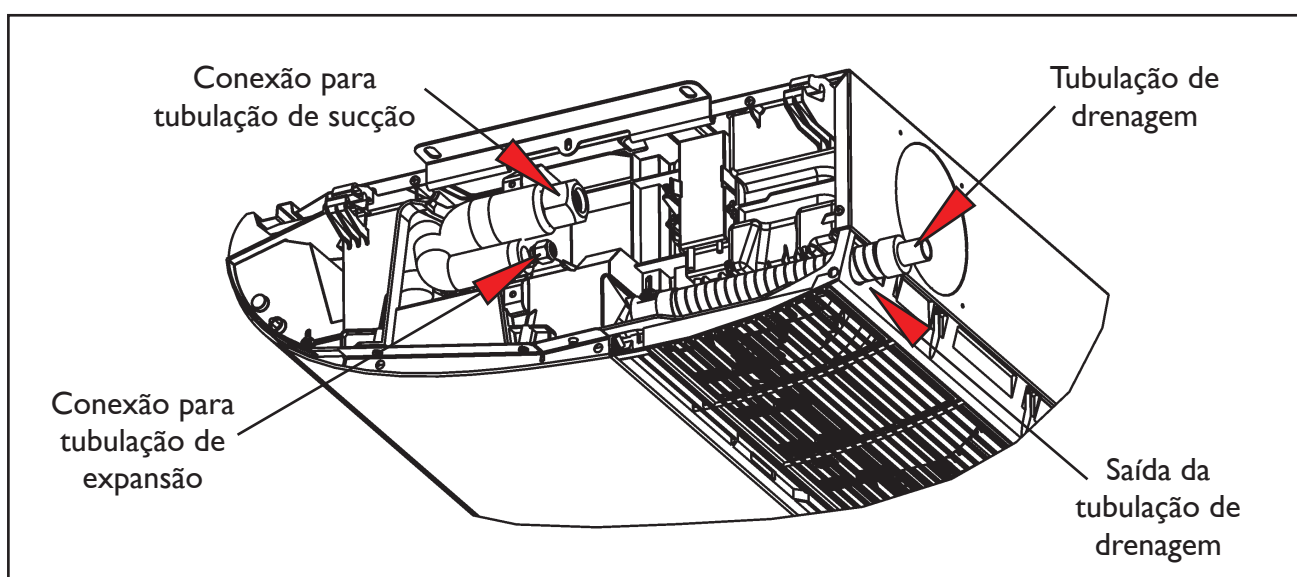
TUBULAÇÕES DE DRENO MONTAGEM TETO
